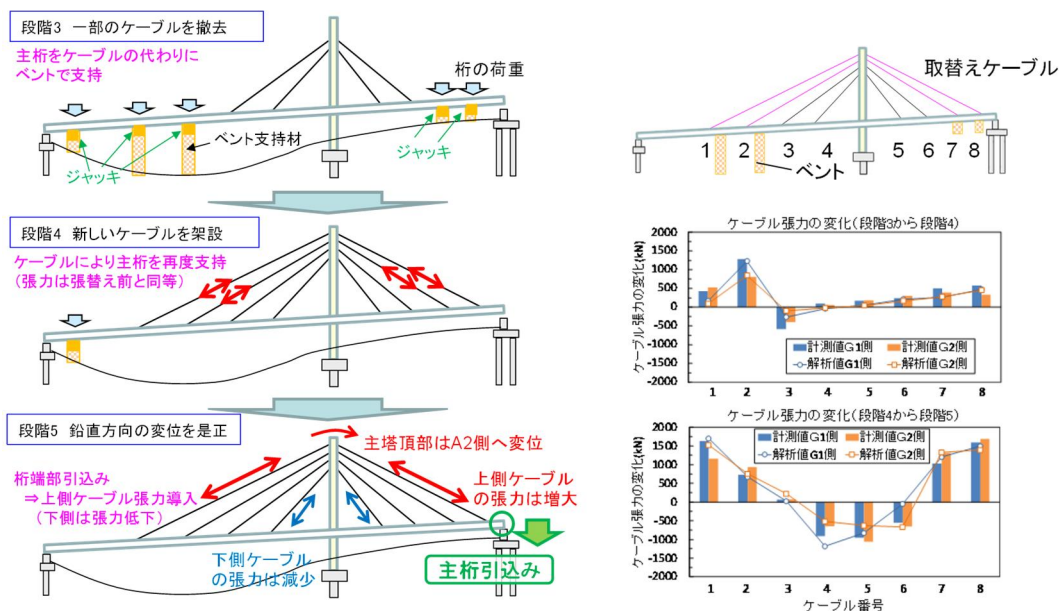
施工ステップの概要とケーブル張力の施工ステップ間（段階3から段階5）の変化
